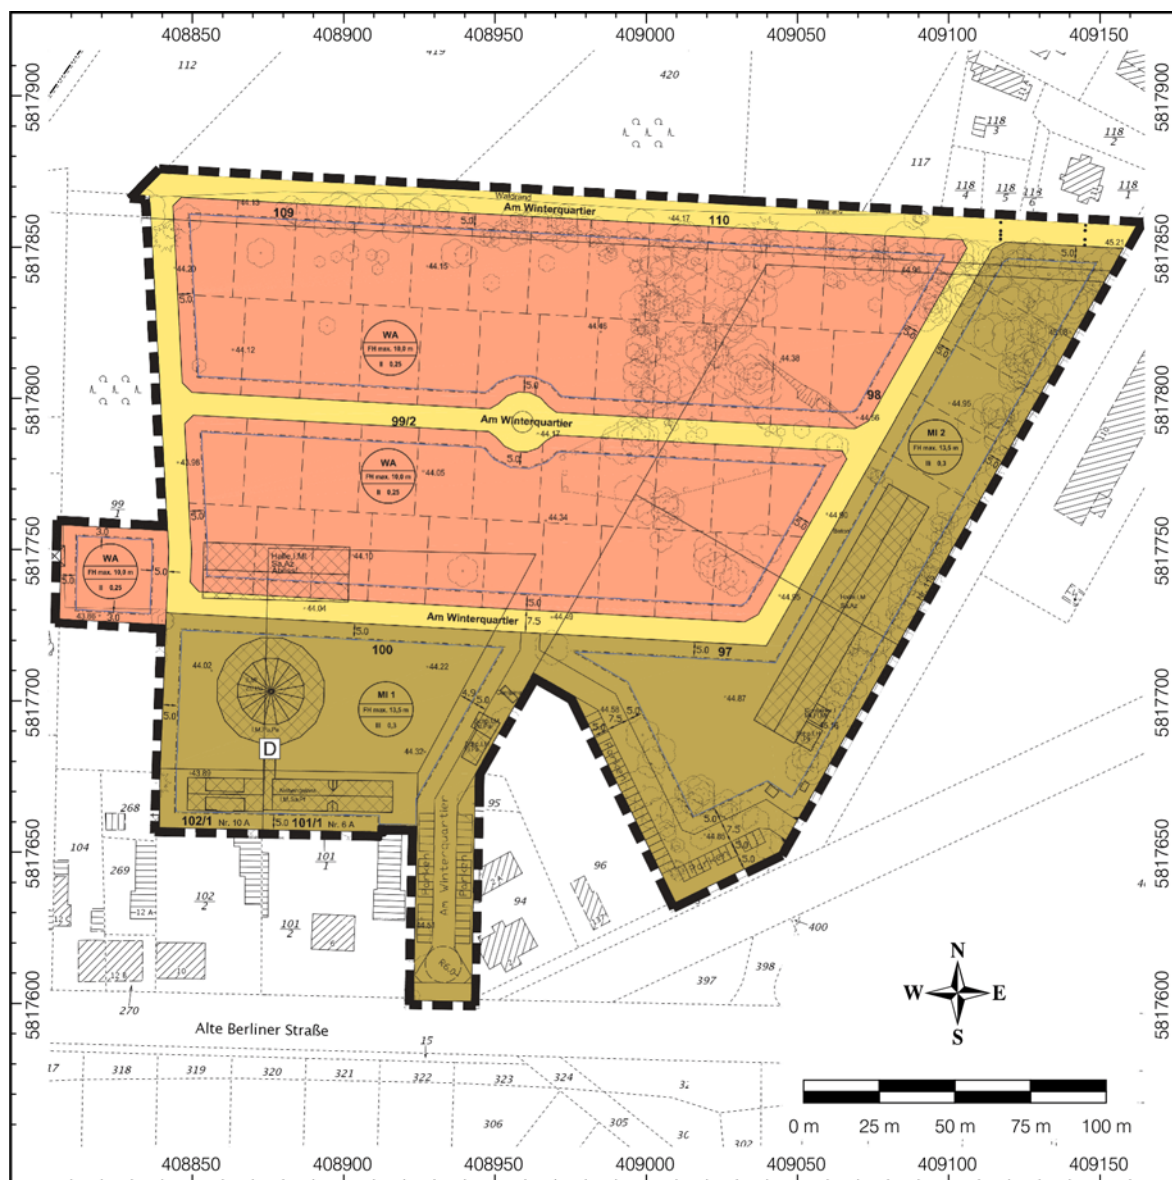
Bebauungsplanentwurf (Stand Mai 2013) mit Darstellung der Bauflächen und Gebietsausweisungen (M 1 : 2.500).
